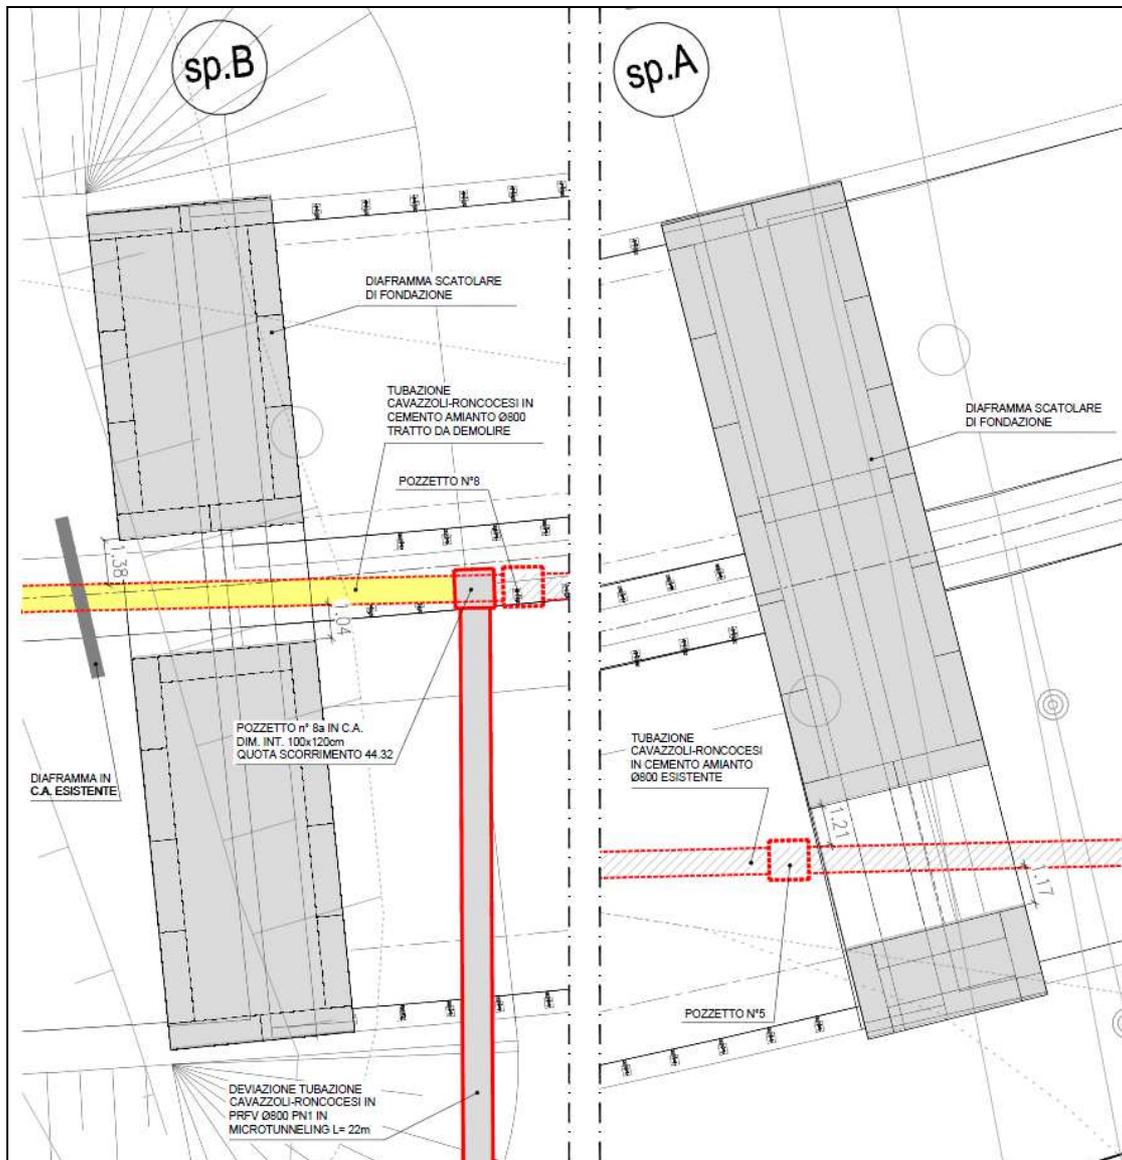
PLANIMETRIA DI DETTAGLIO DELLE FONDAZIONI DEL PONTE E DELLA CONDOTTA CAVAZZOLI-RONCOCESI
